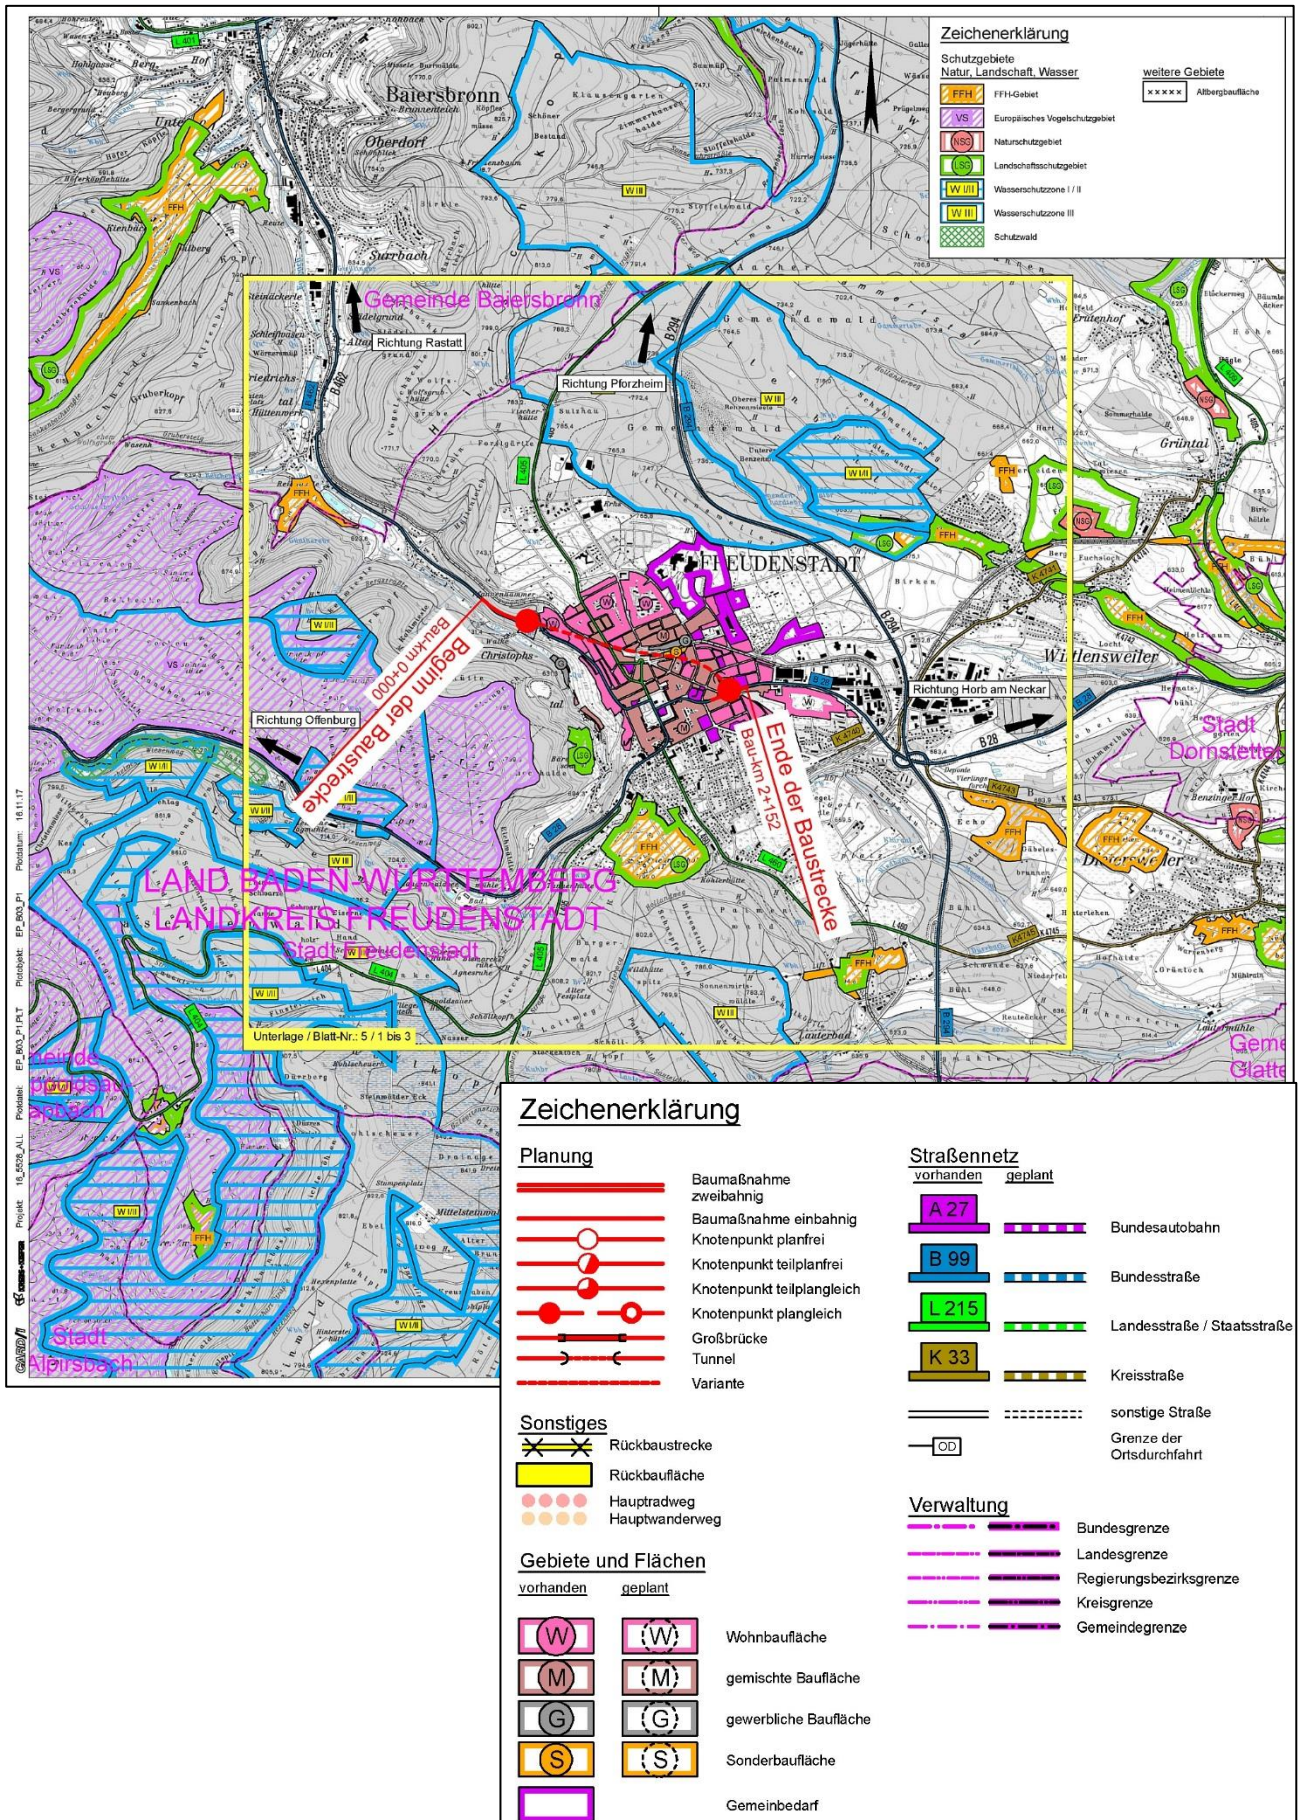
Übersichtslageplan (Feststellungsentwurf / Unterlage 3 / Plan 1)
